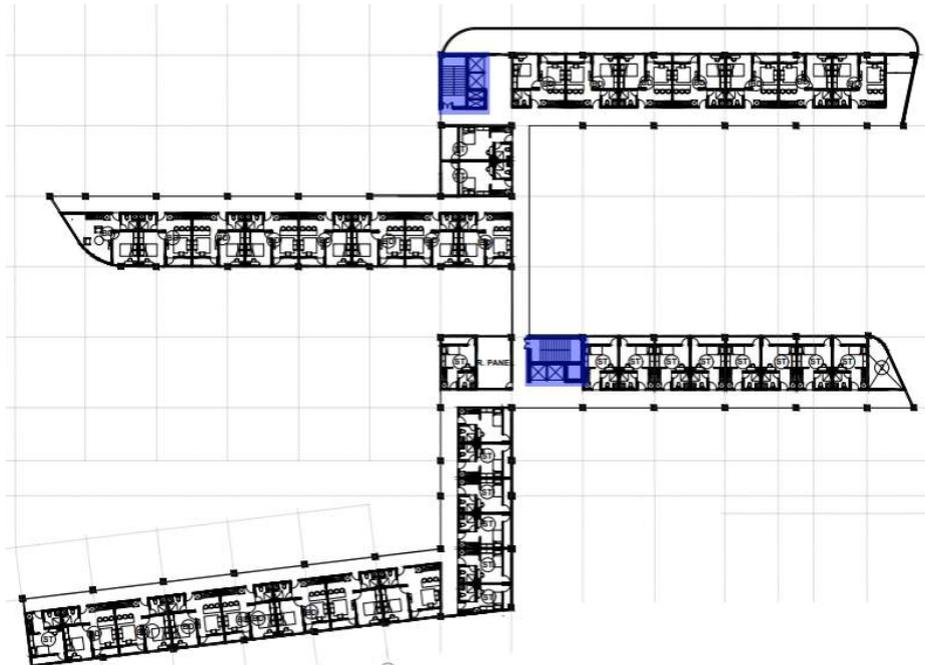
Sirkulasi dalam bangunan (lantai 1-3)
